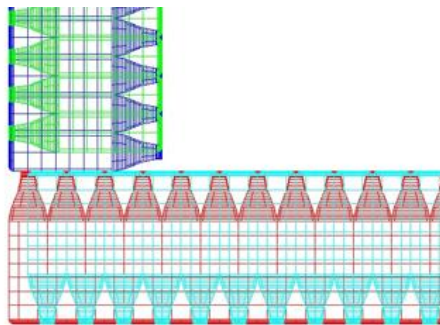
Pormenor dos cantos na nova disposição das garrafas PET, vista de topo.
